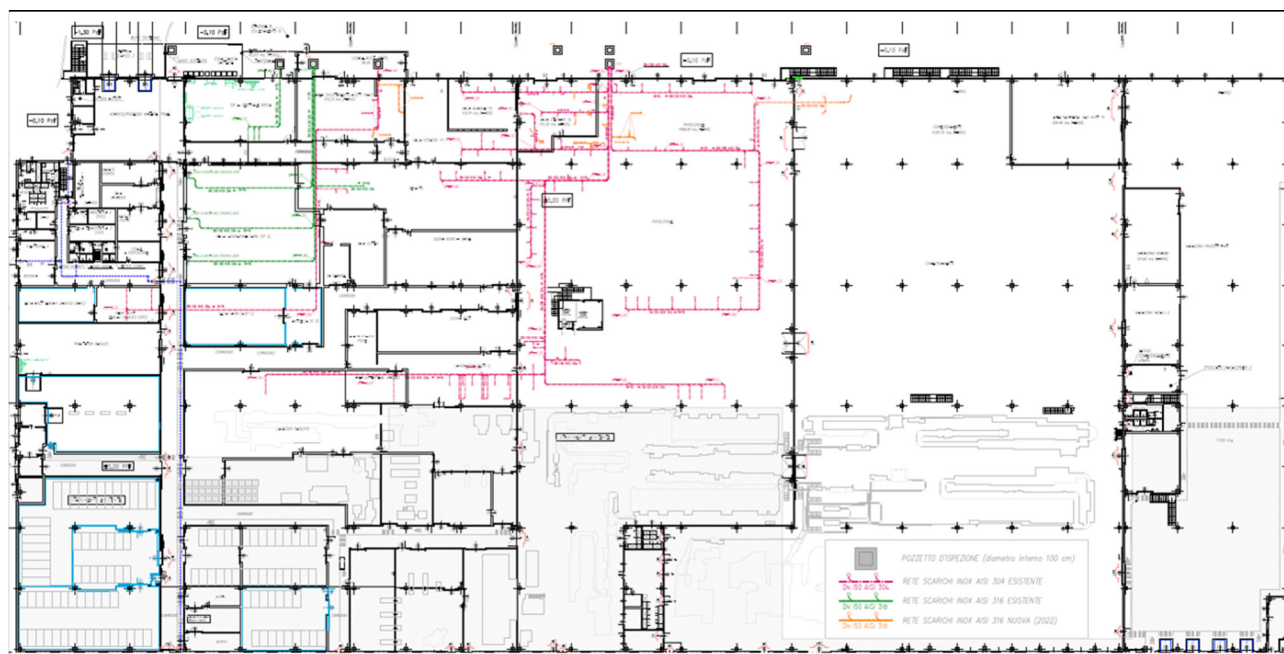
Localizzazione principali interventi di costruzione e demolizione (v. All. 2.1)
